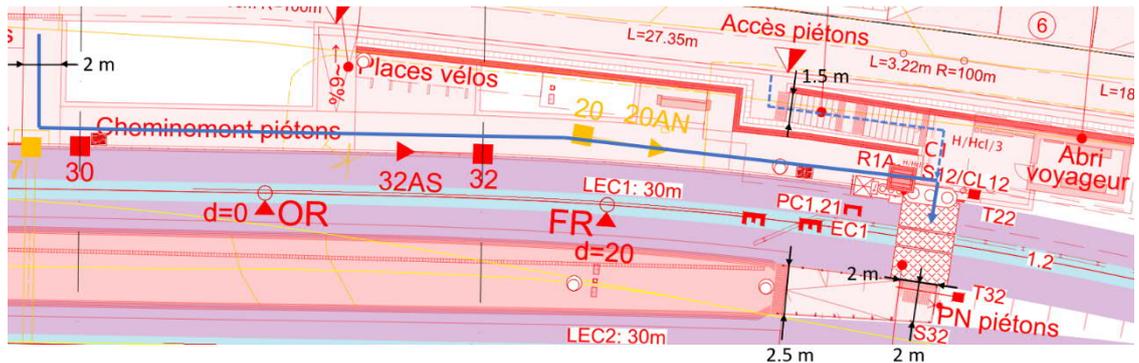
Accès au quai. Plan de situation de la gare (pièce 12.2.1 du dossier PAP).
